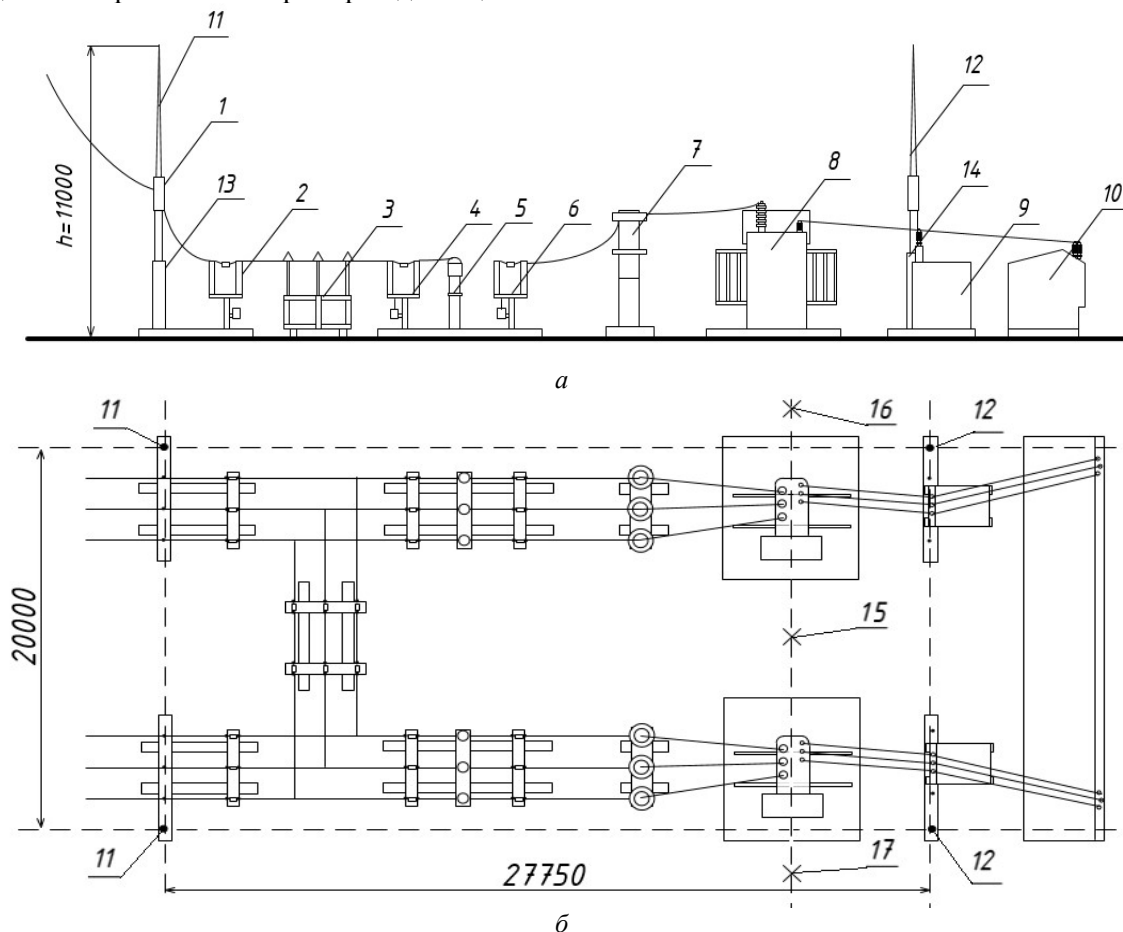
Общий вид подстанции [10] (вид сбоку (а) с оборудованием следующего типа: 1 – блок приема ВЛ- 110 кВ; 2 – разъединитель РНДЗ-2-110/1000-ХЛ1; 3, 4 – разъединитель РНДЗ-1-110/1000-ХЛ1; 5 – блок трансформаторов тока ТФЗМ-110Б; 6 – блок отделитель-короткозамыкатель; 7 – ОПН-П1-110/77/10/2УХЛ1; 8 – силовой трансформатор ТДН-16000/110; 9 – ТСН ТМ-630-10/0,4; 10 – КРУН 10 кВ (шкафы серии К-59); 11, 12 – молниеотвод; 13, 14 – портал; (вид сверху (б)) со стержневыми молниеотводами на порталах; 15, 16, 17 – внешние СМЗ типа МИМ
